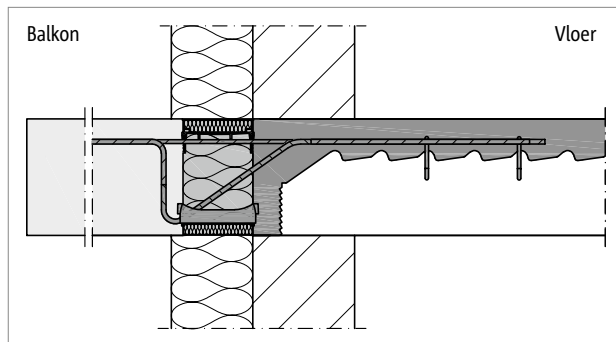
Schöck Isokorf® XT type K-E: Aansluiting bij gevelisolatiesysteem (ETICS)
